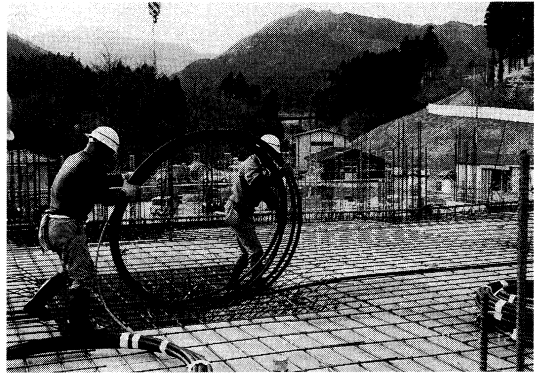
スラブ緊張材の施工状況 (三井建設提供)
